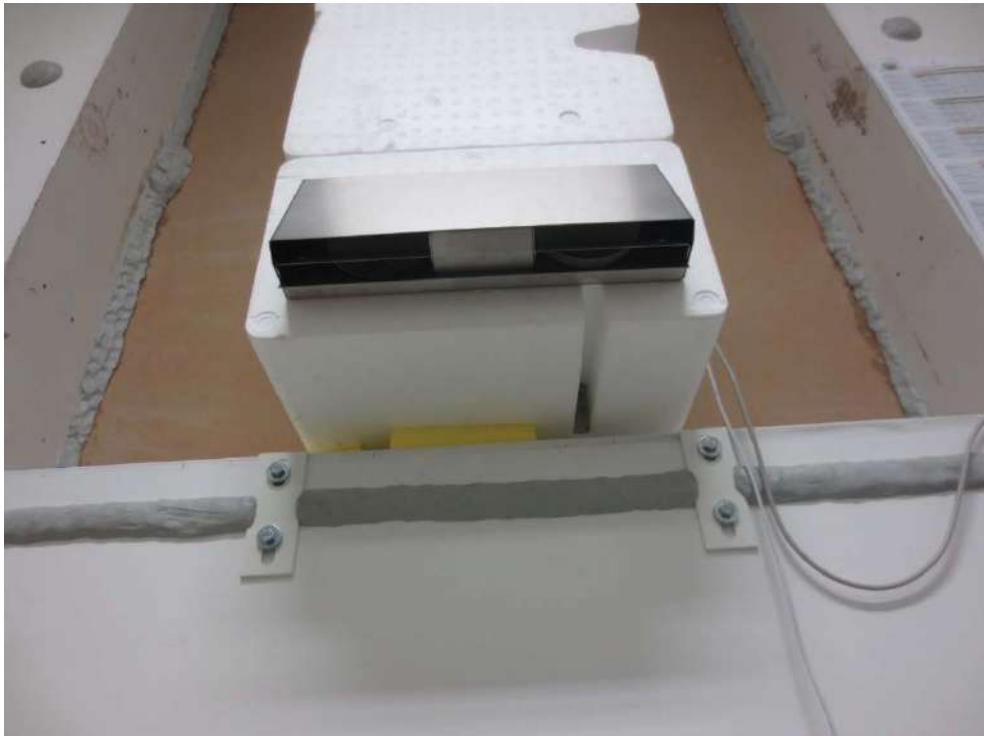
Ansicht Außenseite von schräg unten (prüffertig): Fassadenabschluss Edelstahlscote auf Mauerkasten montiert mit Außenöffnungen (FOL links, AUL rechts).
